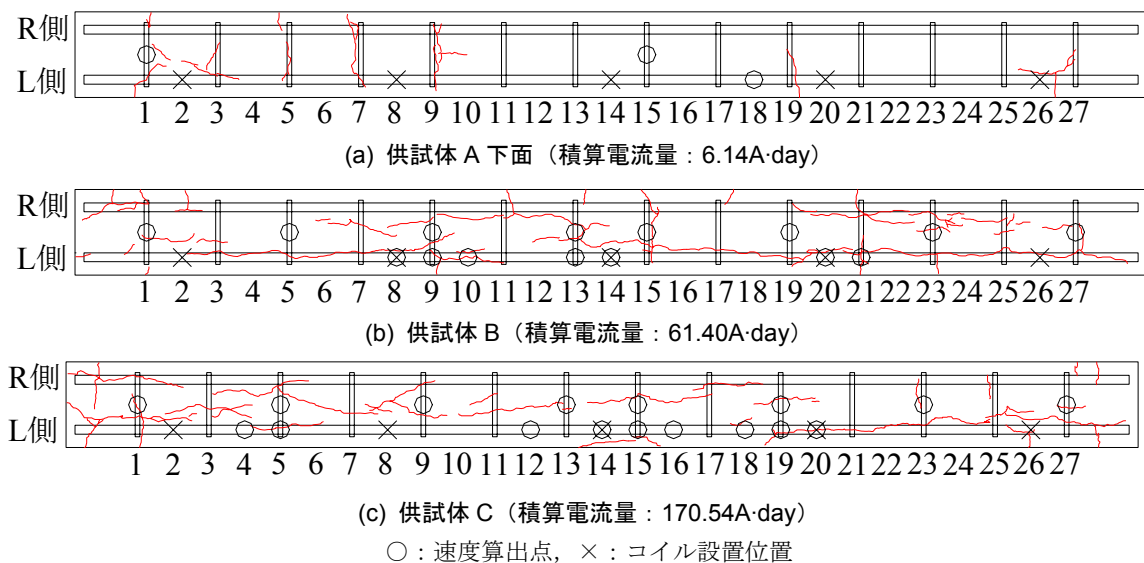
ひび割れ発生状況と超音波法および電磁パルス法での計測位置
